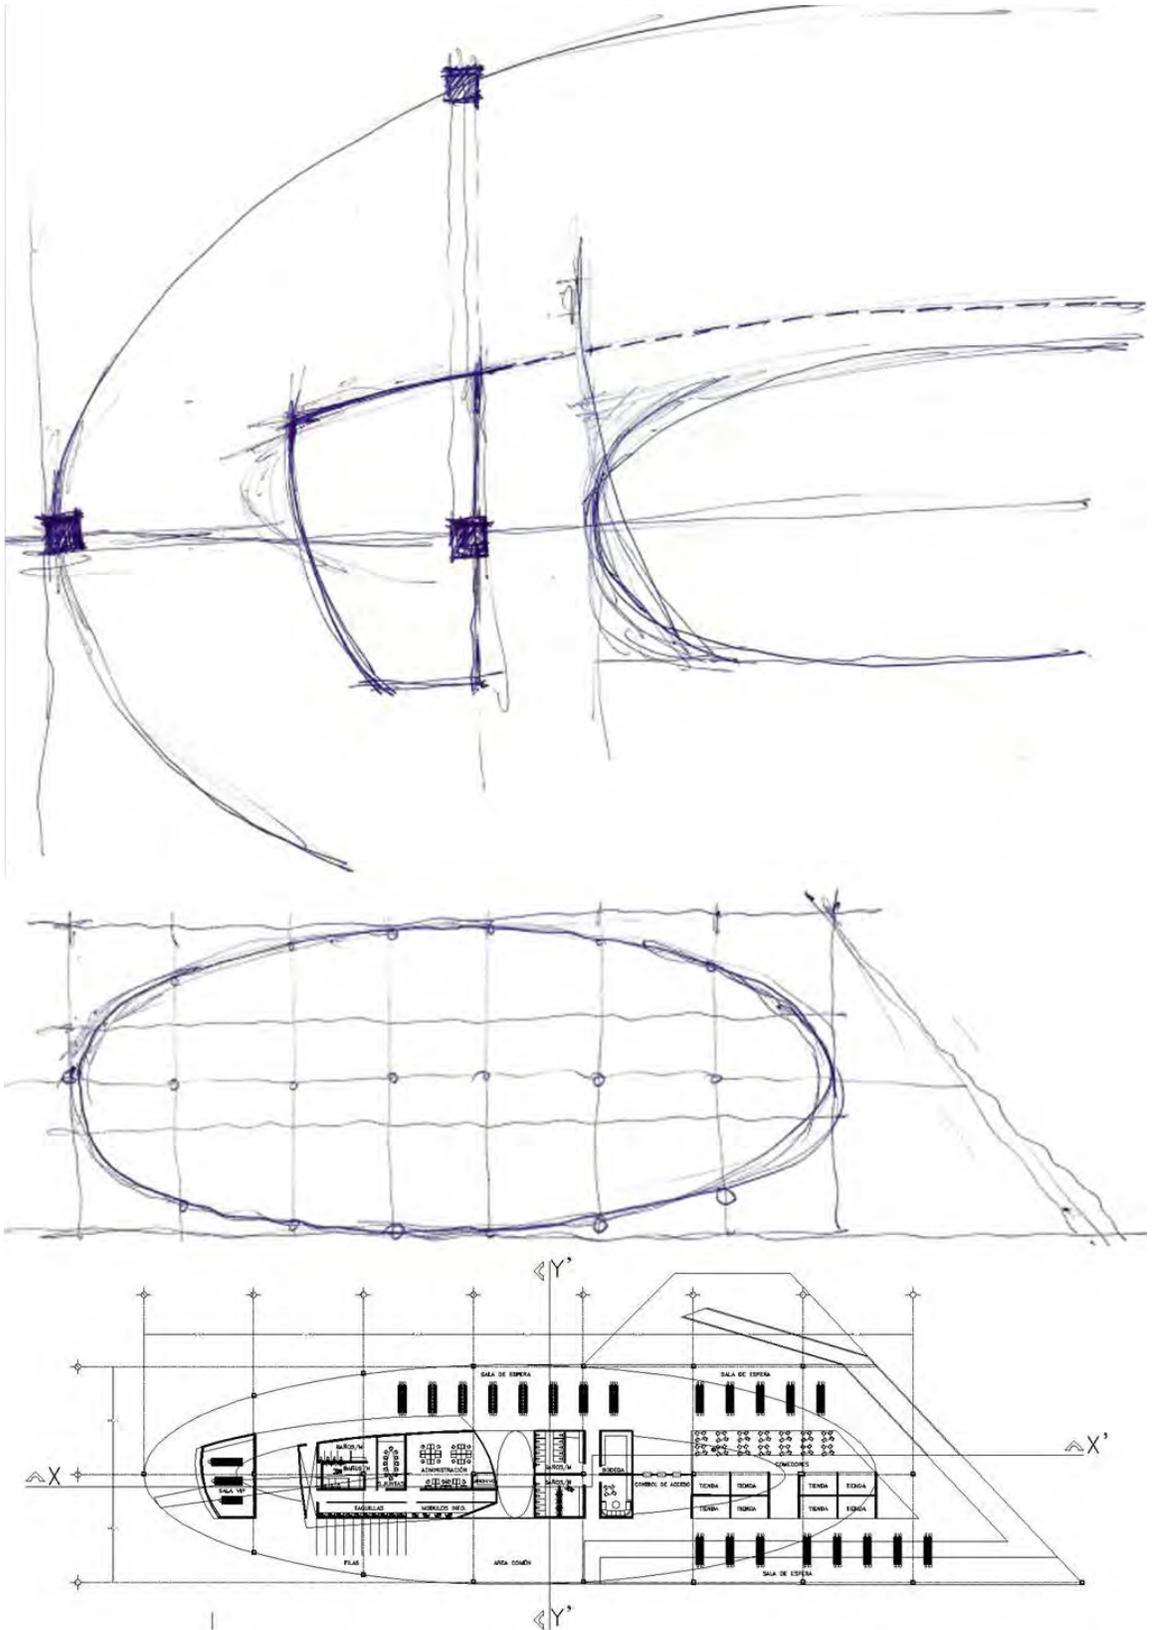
Proceso evolutivo de forma y estructura, en planta baja.
